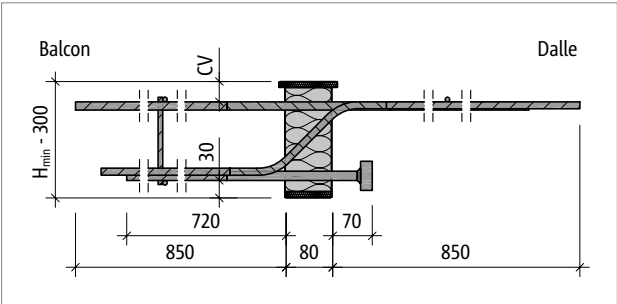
Schöck Isokorb® T type K-T-M13 : coupe du produit
